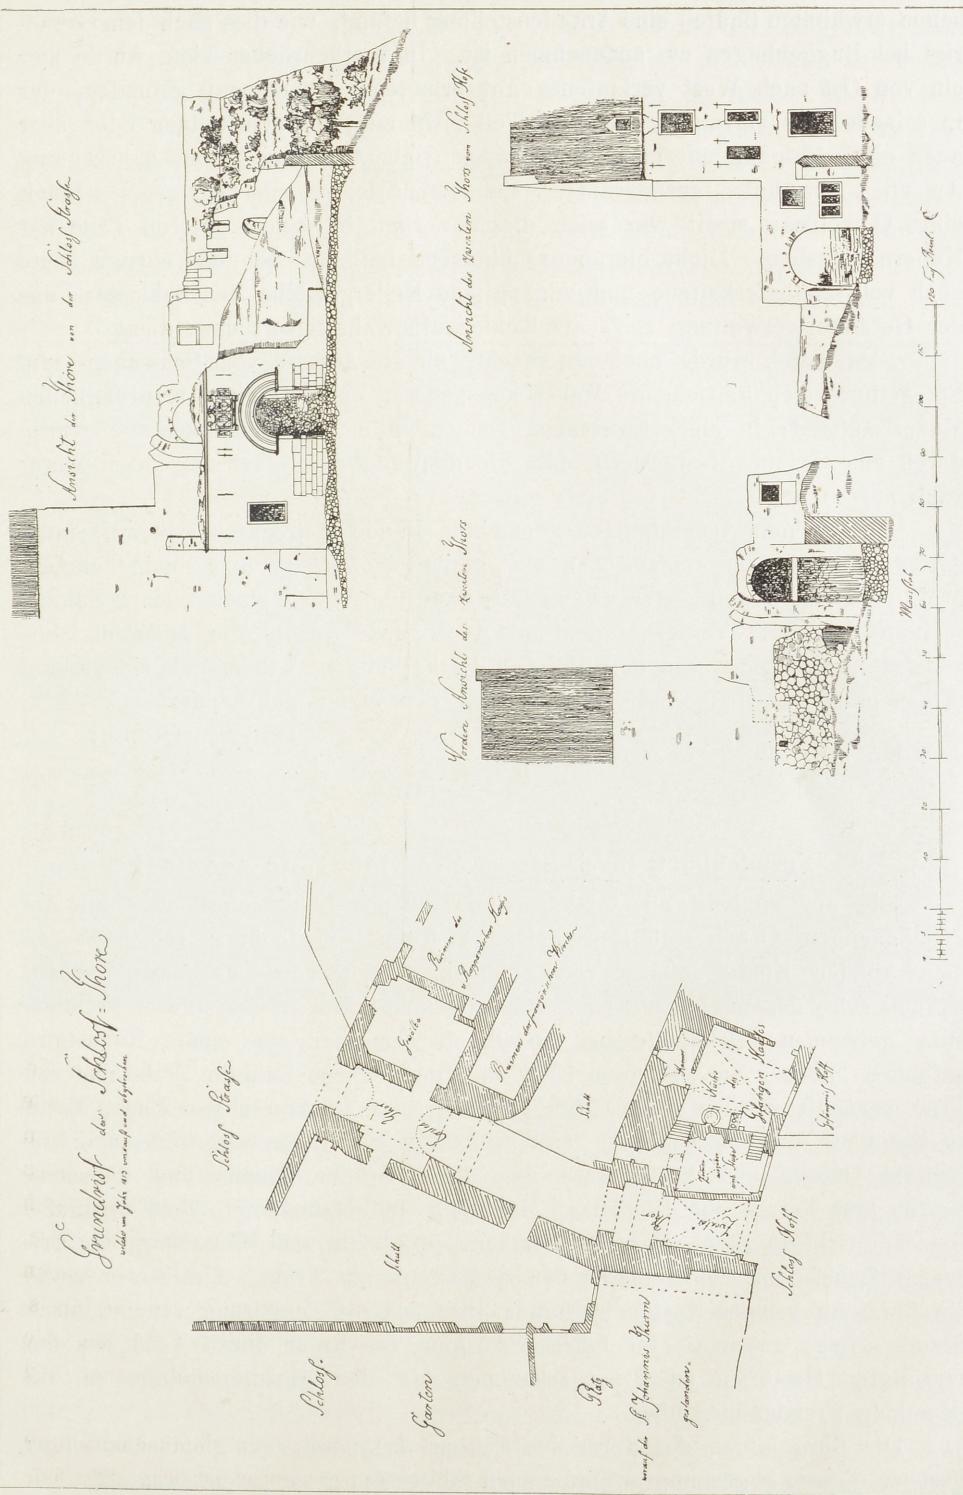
Cleve, Schloss. Grundriss und Ansichten der im Jahre 1813 abgebrochenen Schlosstore.
